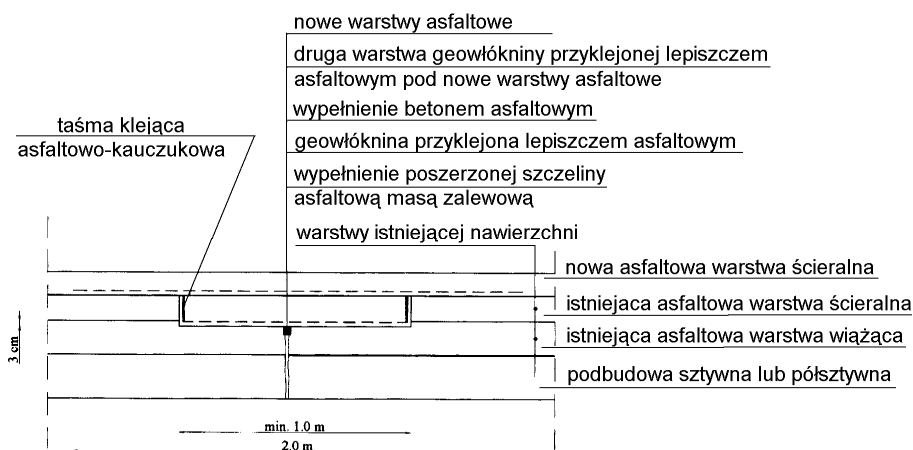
Wzmocnienie silnie uszkodzonej nawierzchni z betonu cementowego warstwami asfaltowymi
